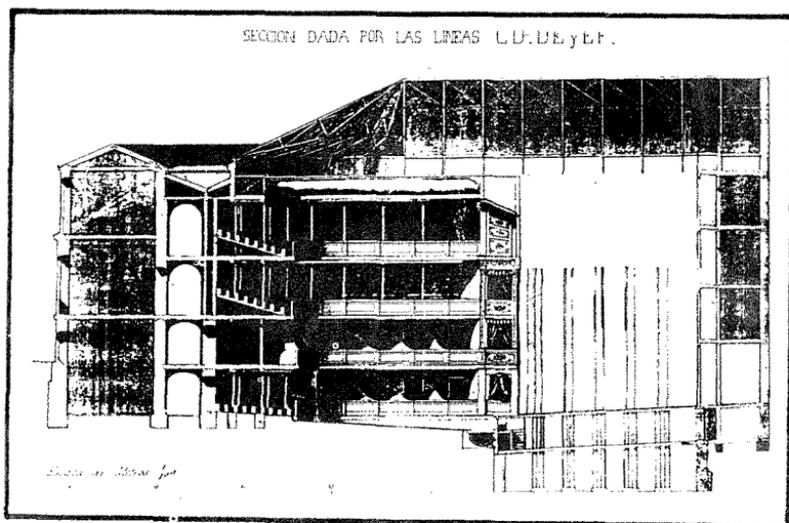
Proyecto de 1866. Alzado interior, corte longitudinal de la sala (A.M.T.).
